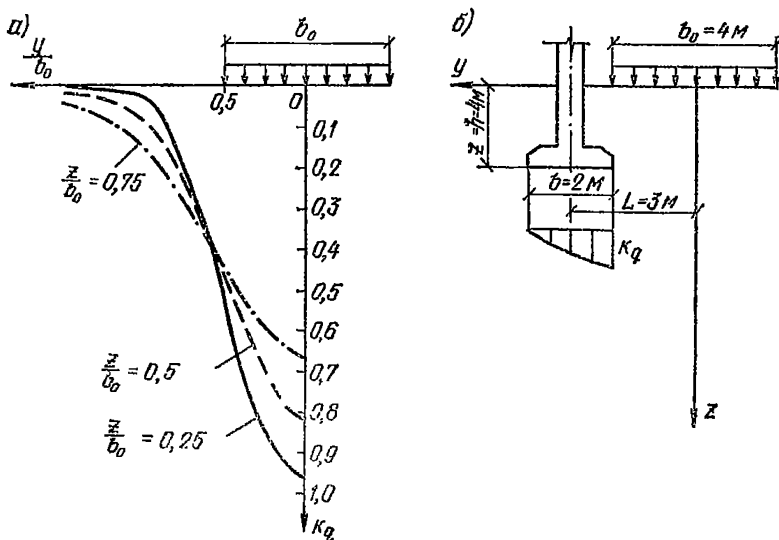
Расчетные схемы для учета влияния полосовой нагрузки на деформацию основания
